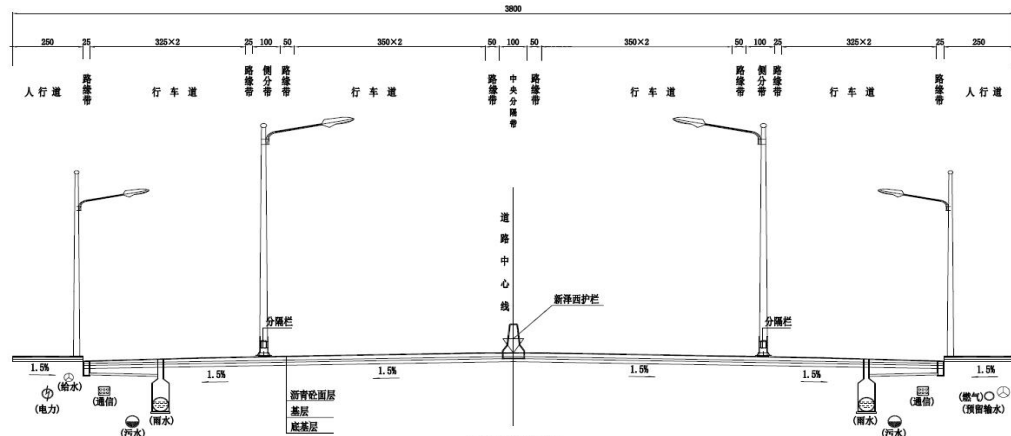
旺苍境 38m 宽路基横断面图
